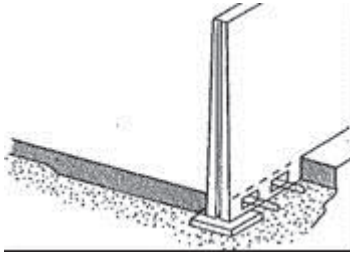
Aarden wal met betonplaten (tek C.B.I. 3383).
